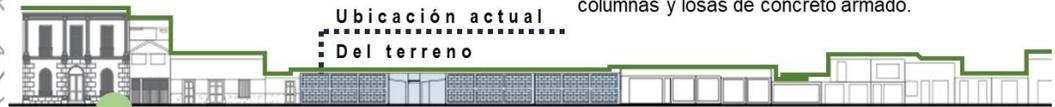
Perfil urbano 1, Fuente: Elaboración propia.
